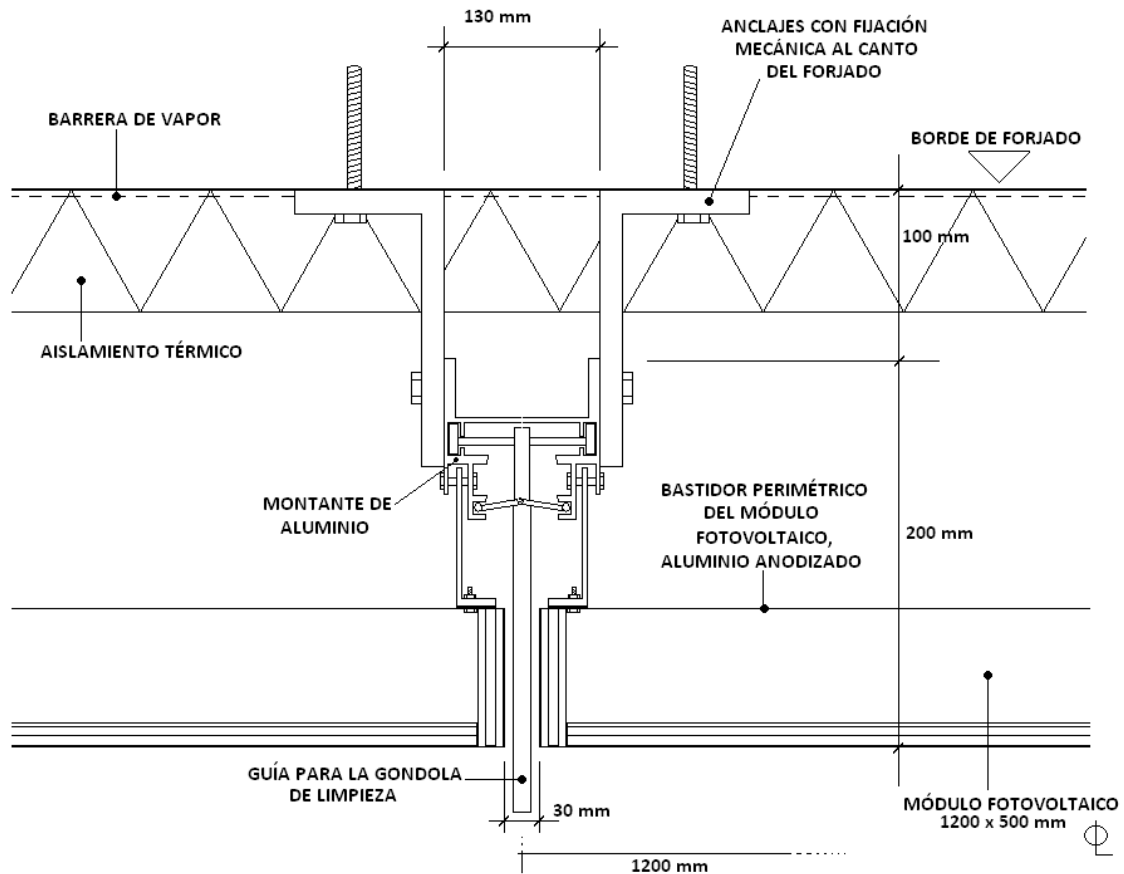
Solución constructiva en corte horizontal por una fachada ventilada.
